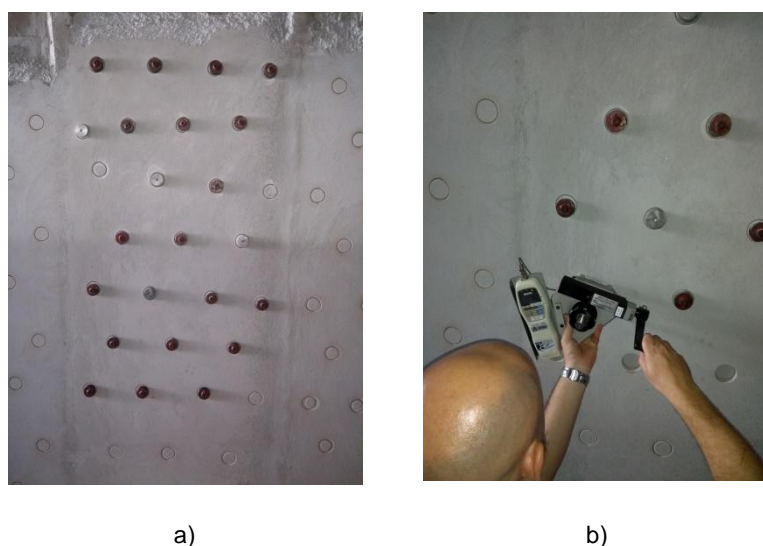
ensaio de aderência à tração a) corpos de prova cortados com pastilhas coladas e; b) execução do ensaio de arrancamento
